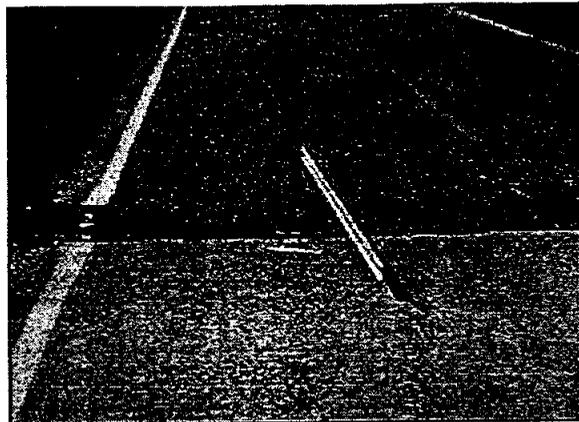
Fisura Parabólica o por Deslizamiento – Baja Severidad
